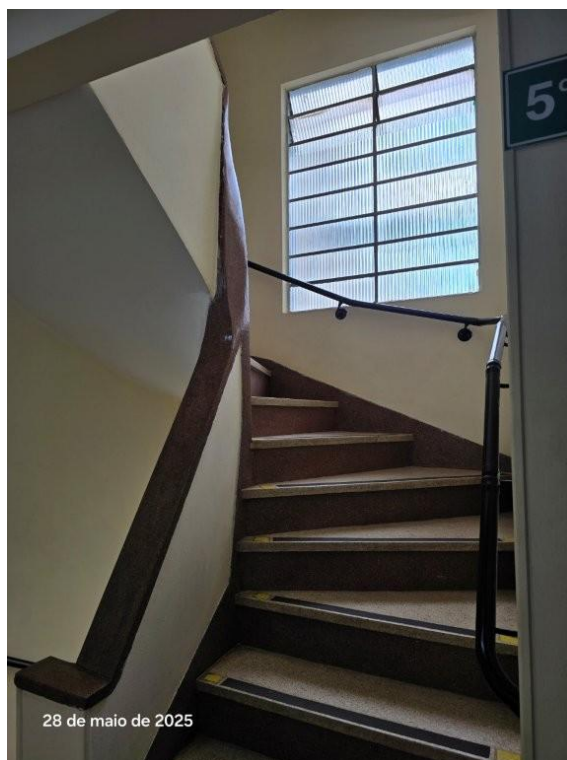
Vista geral das escadas de acesso aos pavimentos inferiores e superiores
